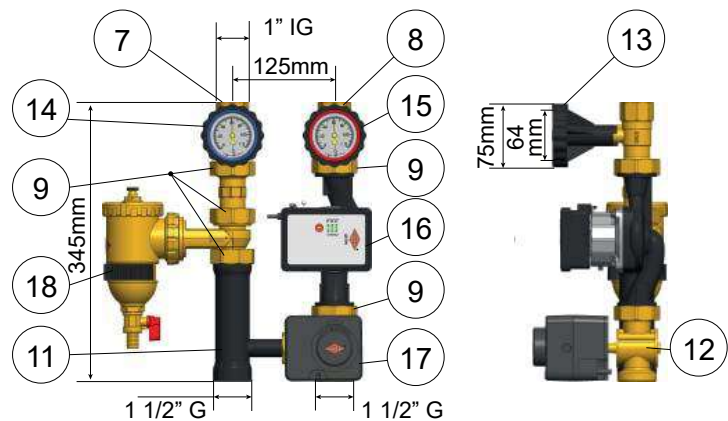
Pumpengruppe DN 25 gemischter Heizkreis
